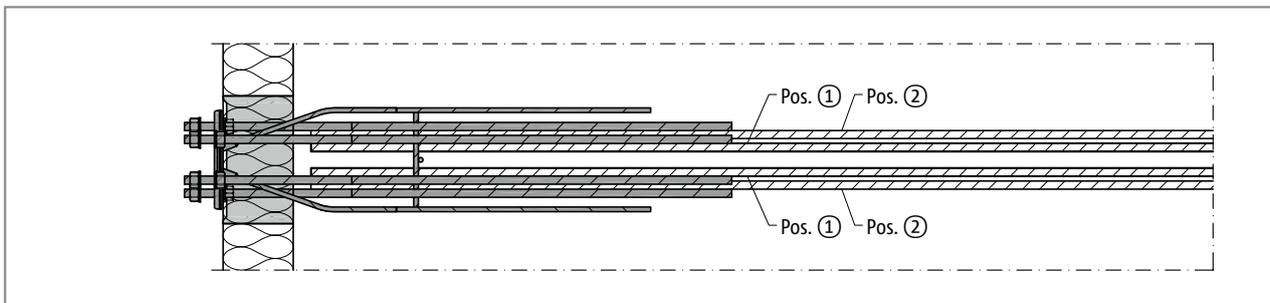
Schöck Isokorb® XT Typ SK-MM1-VV1: Bauseitige Bewehrung, Grundriss
